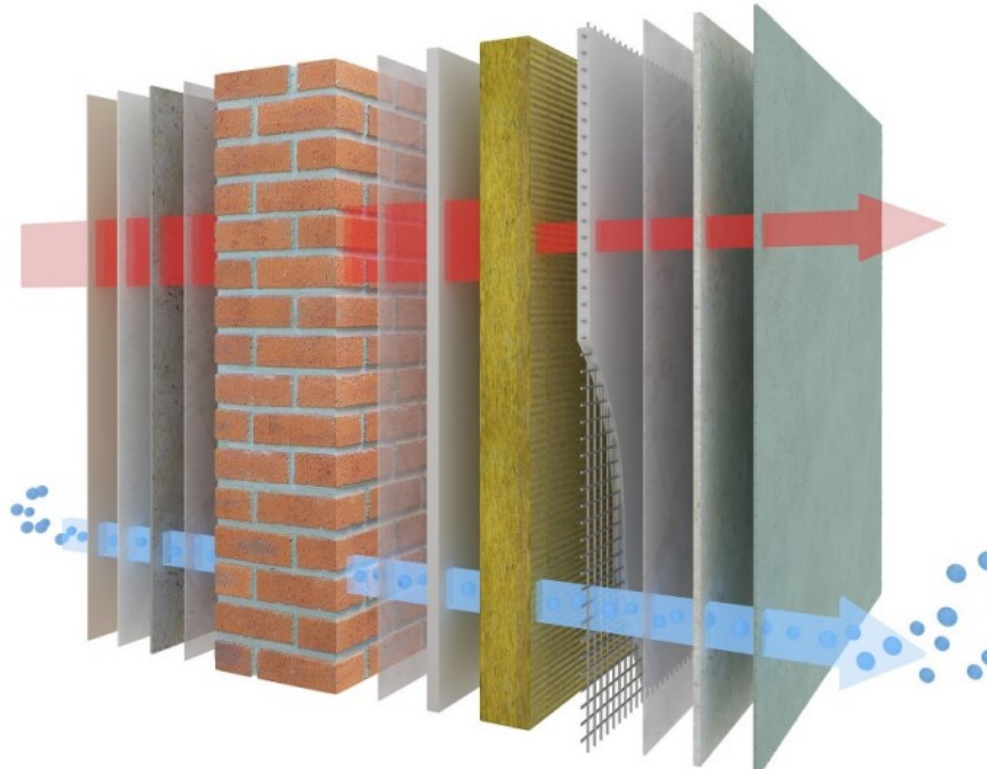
Конструкція системи типу «мокрый фасад»
